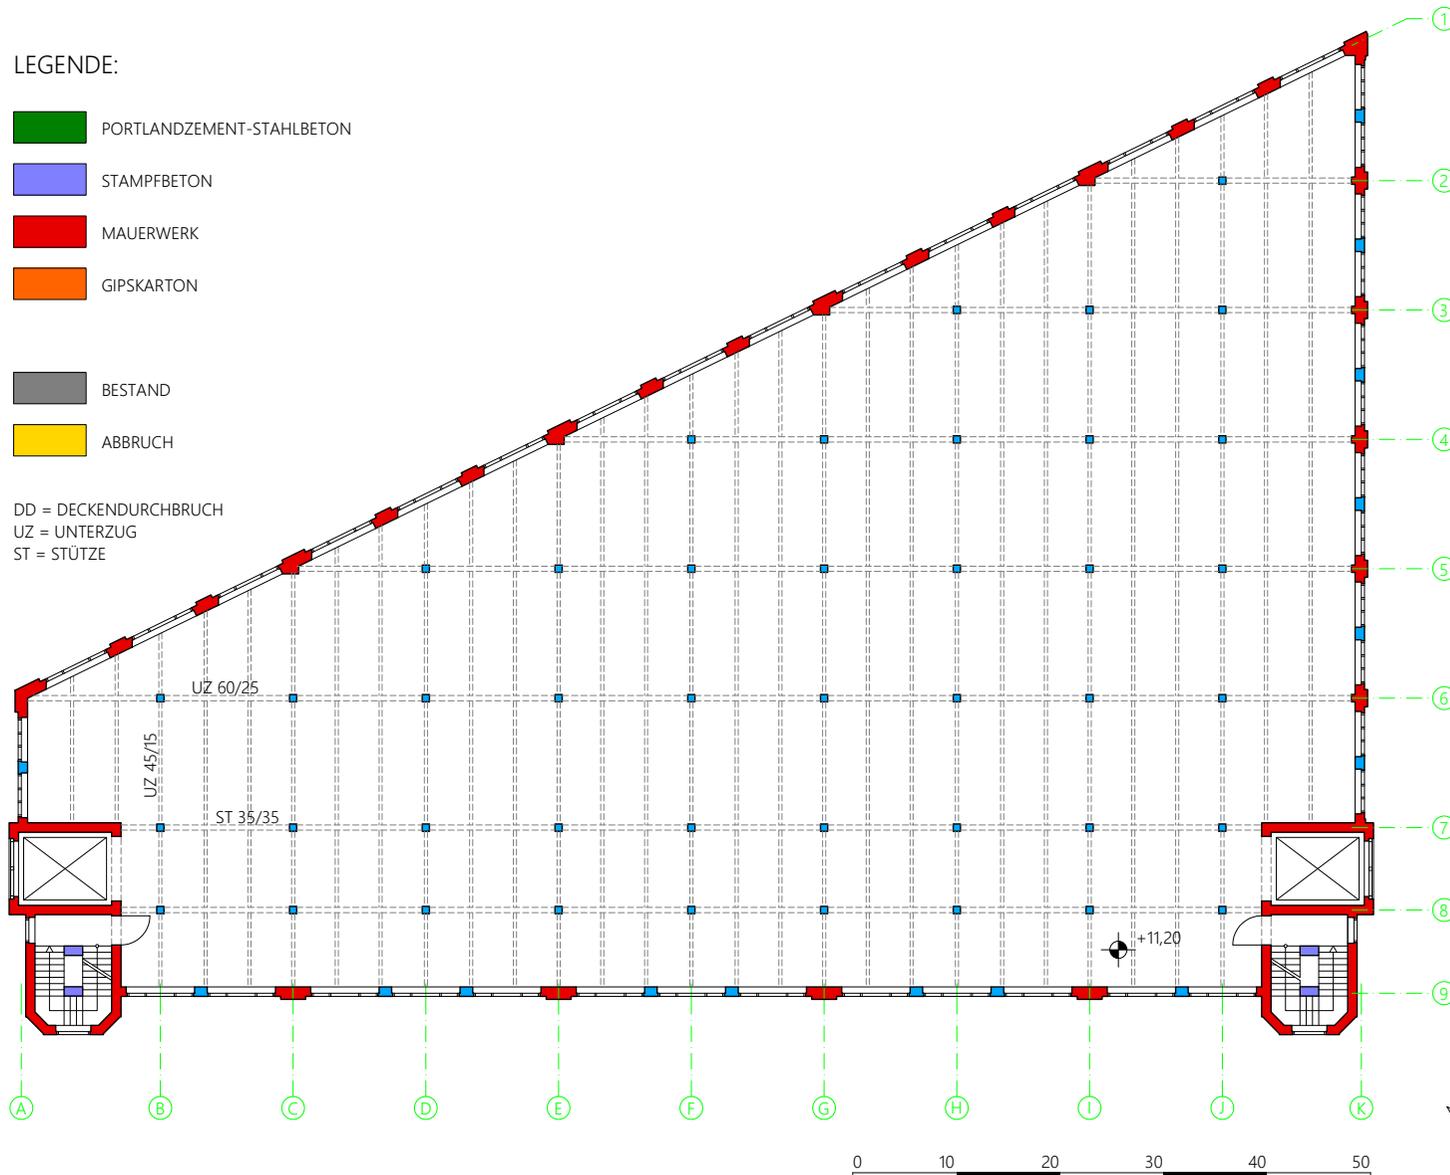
Bauphasenplan 1913: Drittes Obergeschoß des Maschinenmagazins
